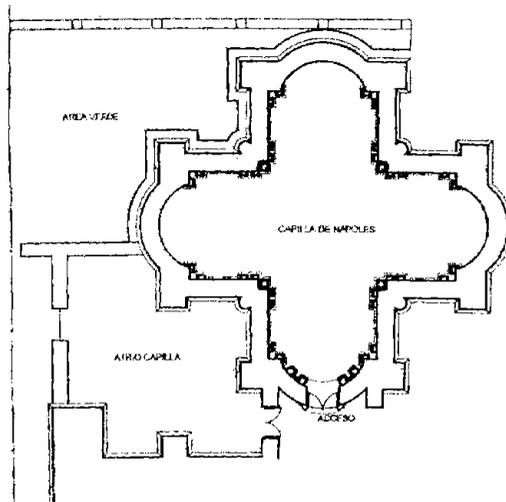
Planta de la Capilla de Nápoles en Guadalupe, Zacatecas.
